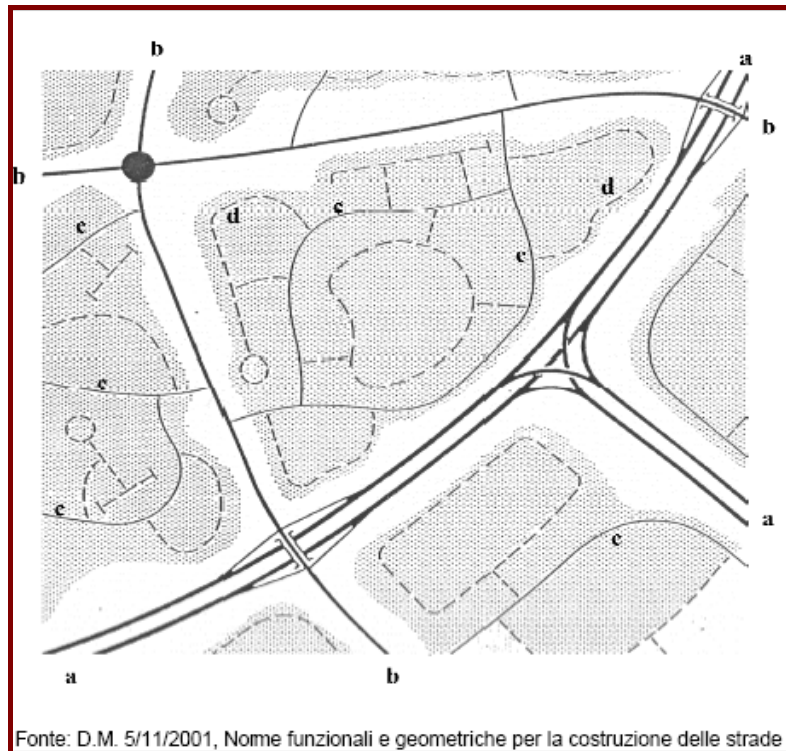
7 - Schema tipo del reticolo stradale (a – rete primaria; b – rete principale; c – rete secondaria; d – rete locale)
